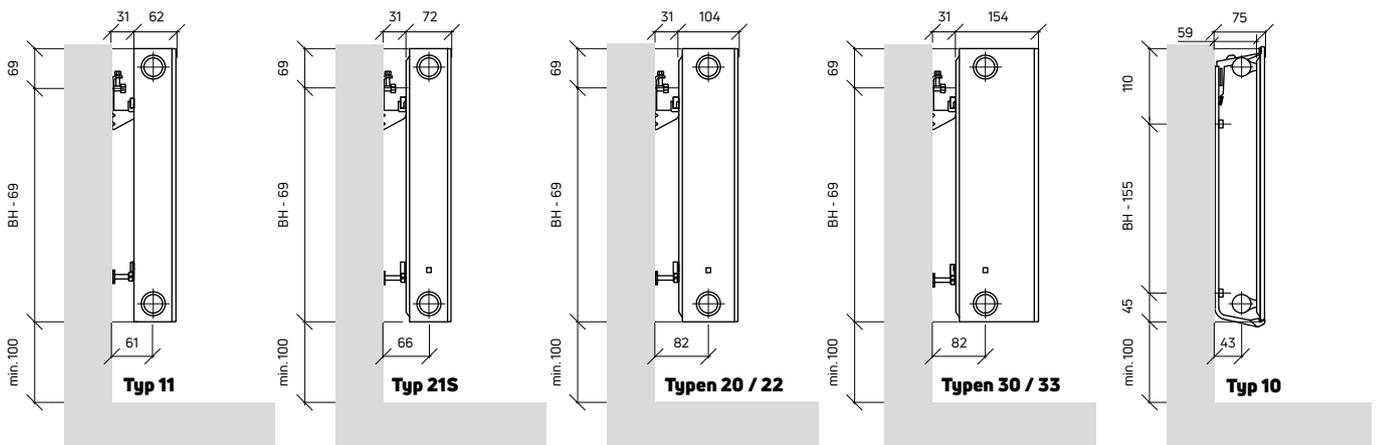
Montagemaße für Plan Compact und Ramo Compact mit Befestigungslaschen
